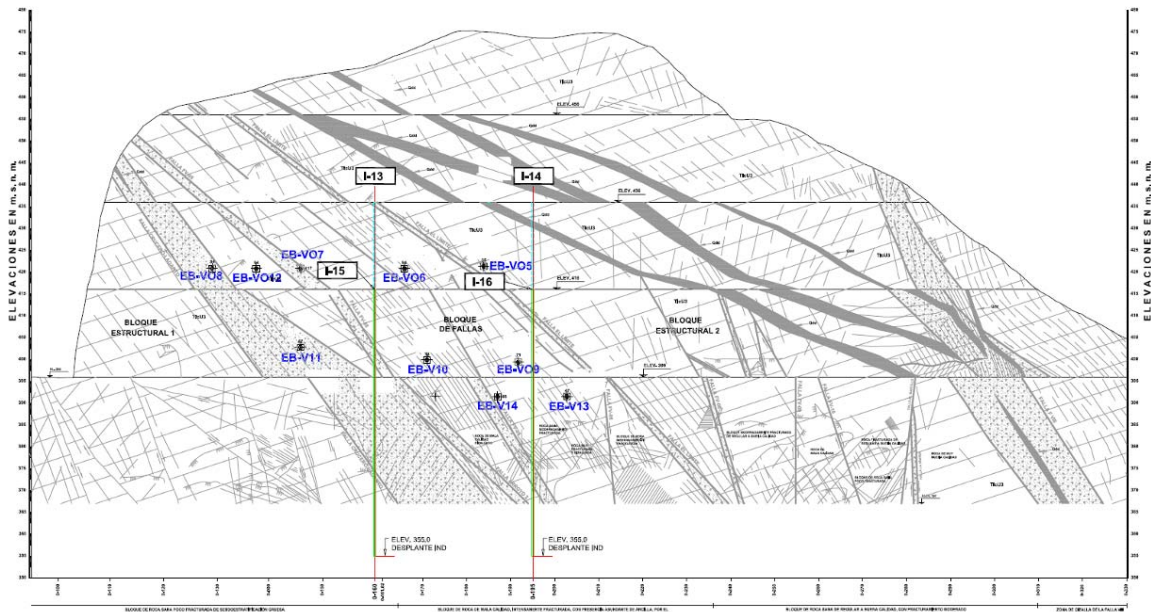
Instrumentación instalada en el Talud derecho del canal de llamada de la obra de excedencias
